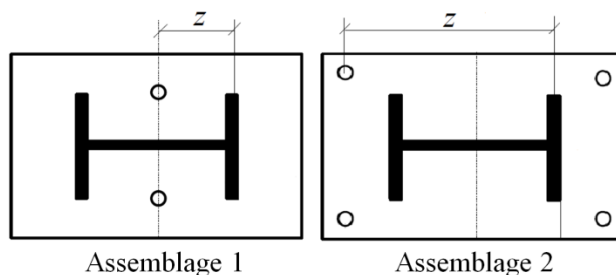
Bras de leviers les plus défavorables selon le type d'assemblage considéré en pied de poteau
